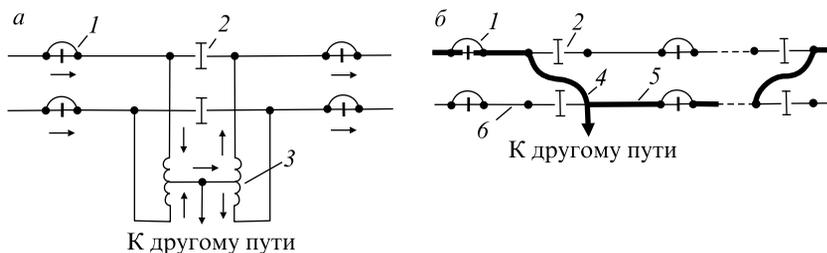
Схема электрических соединителей в рельсовой цепи на участках, оборудованных автоблокировкой с двухниточными (а) и однониточными (б) рельсовыми цепями; 1 и 4 — стыковой и продольный электрические соединители; 2 — изолирующий стык; 3 — дроссель-трансформатор; 5, 6 — электротяговая и нетяговая рельсовые цепи
